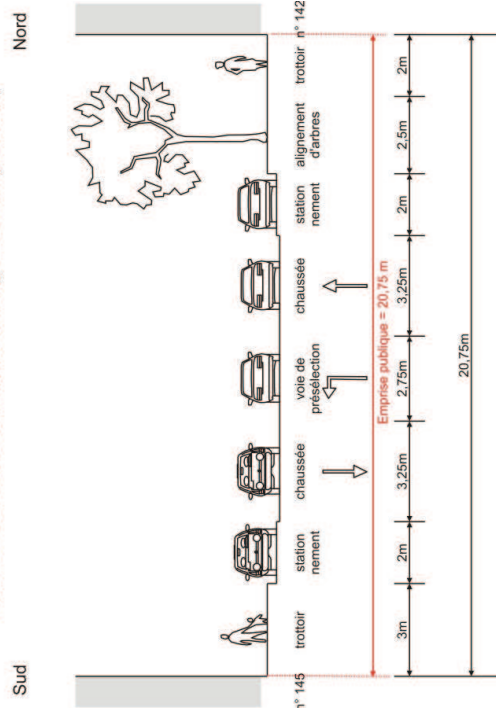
Situation existante. Route de Mittelhausbergen/Ouest
